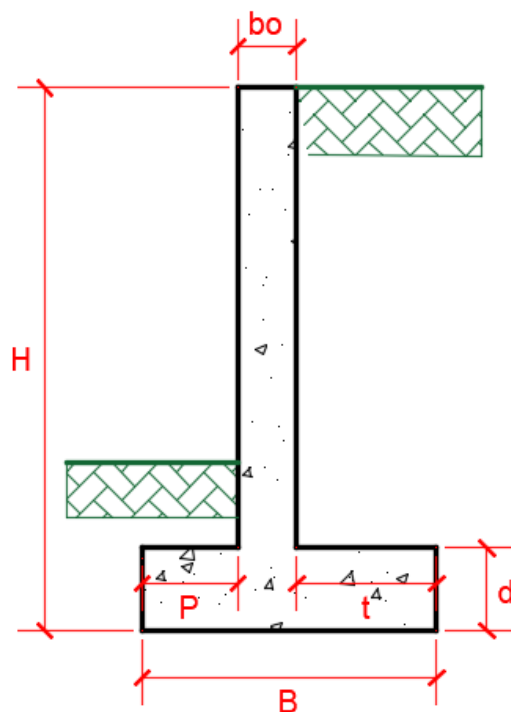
Elementos de un muro en voladizo. Autores (2020).
